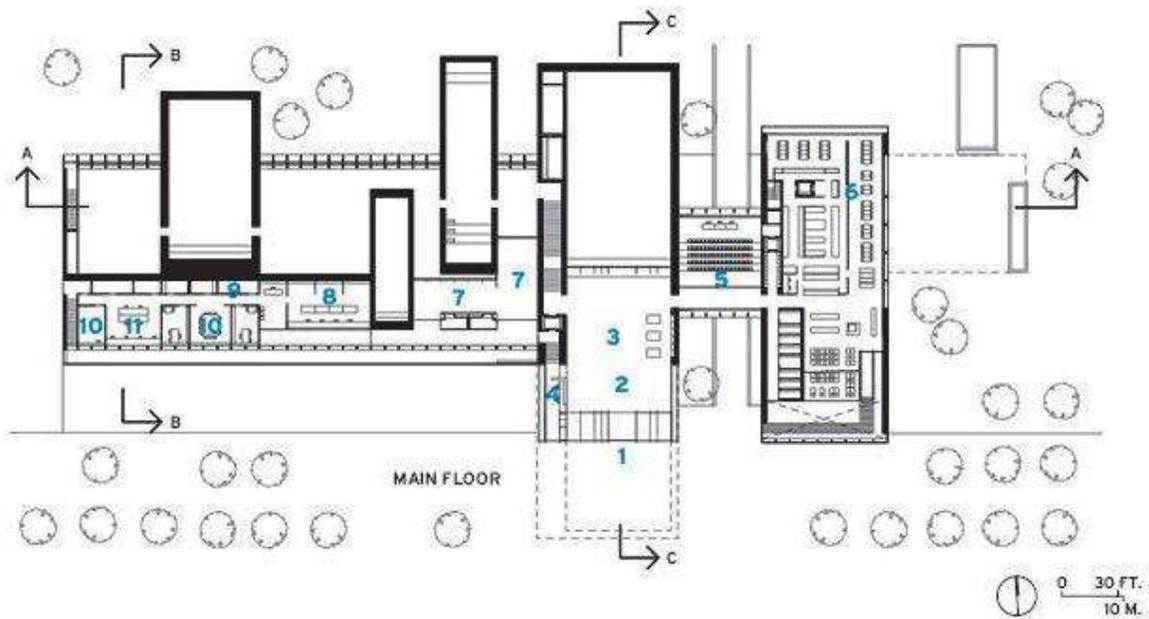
Planta baja Soulanges museo, Fuente: <http://jaumeprat.com/rcr-architectes-museo-pierre-soulanges-rodez/Plantabaja>. Victor Hugo
